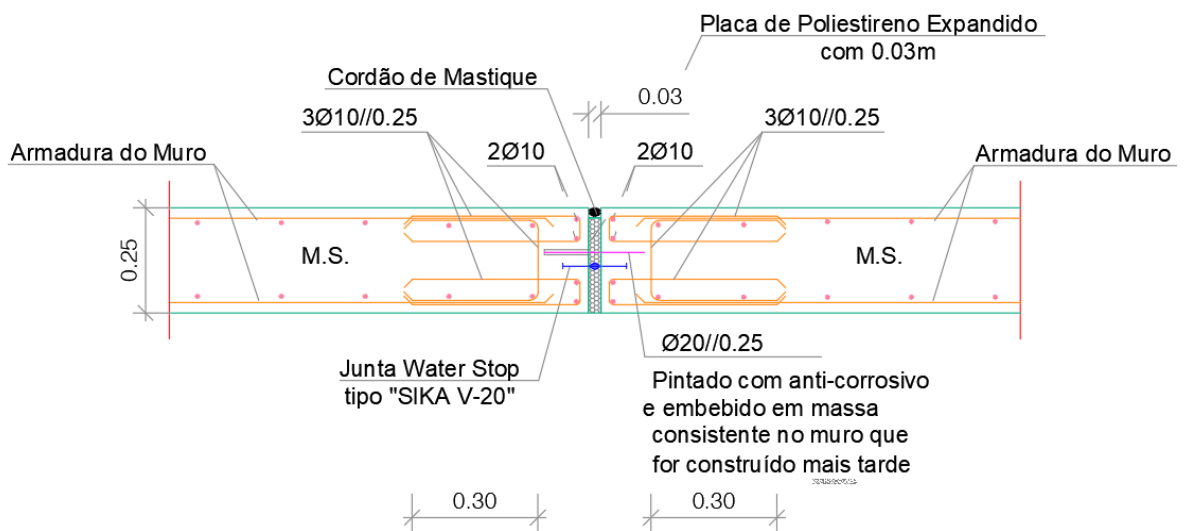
Junta de Dilatação em Muros de Suporte (Projeto de estruturas).
